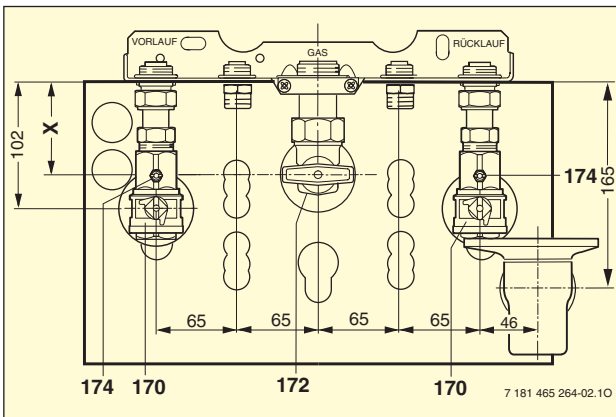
Montageanschlussplatte mit Unterputz-Installation (fertig montiert)
